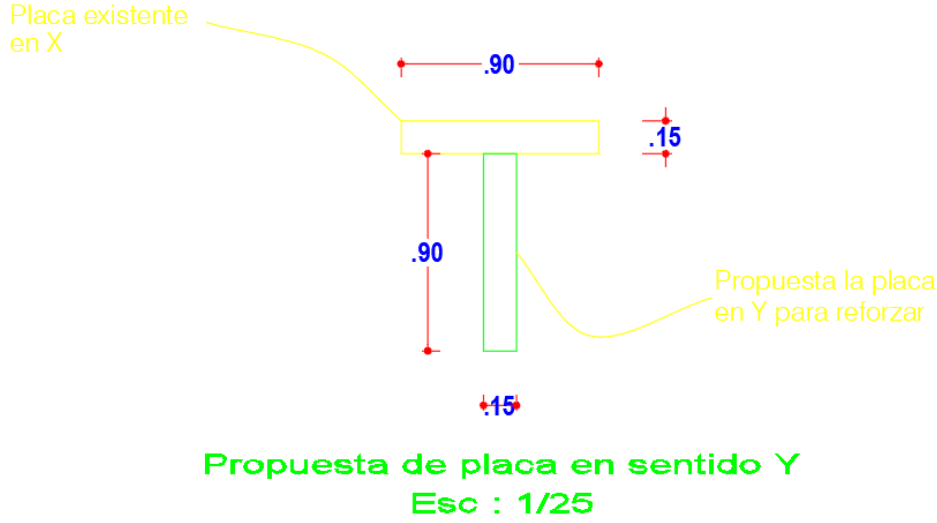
Propuesta de una placa en sentido Y – pabellón A
